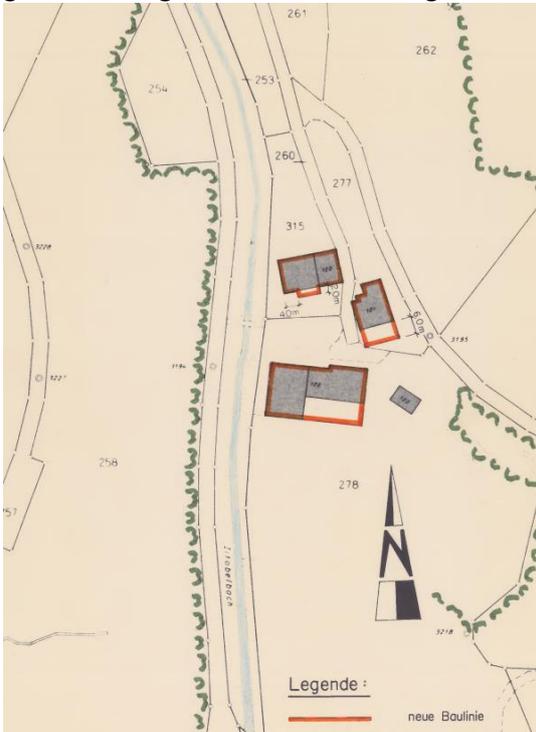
Planausschnitt BLP 'Itobel' 1988
